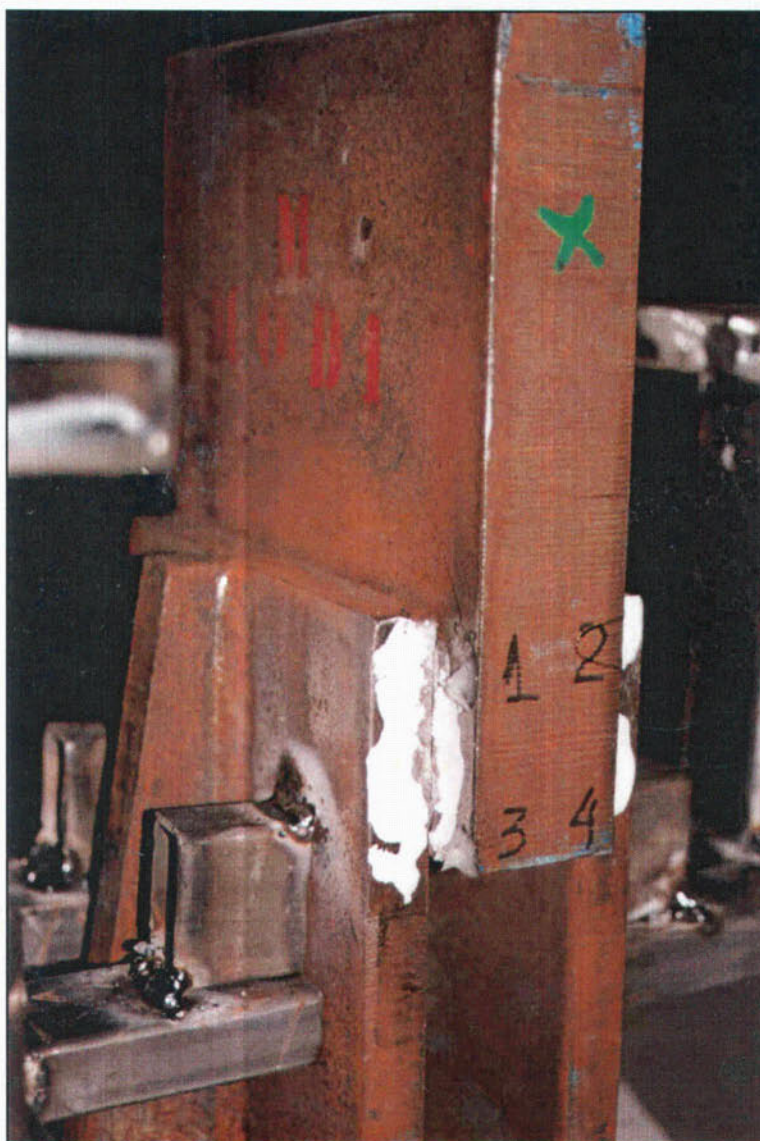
Probeta 1M después del ensayo. Se observa la rotura por el plano de garganta en la soldadura 1-3. La cal se encuentra desprendida en dicha zona de rotura.
